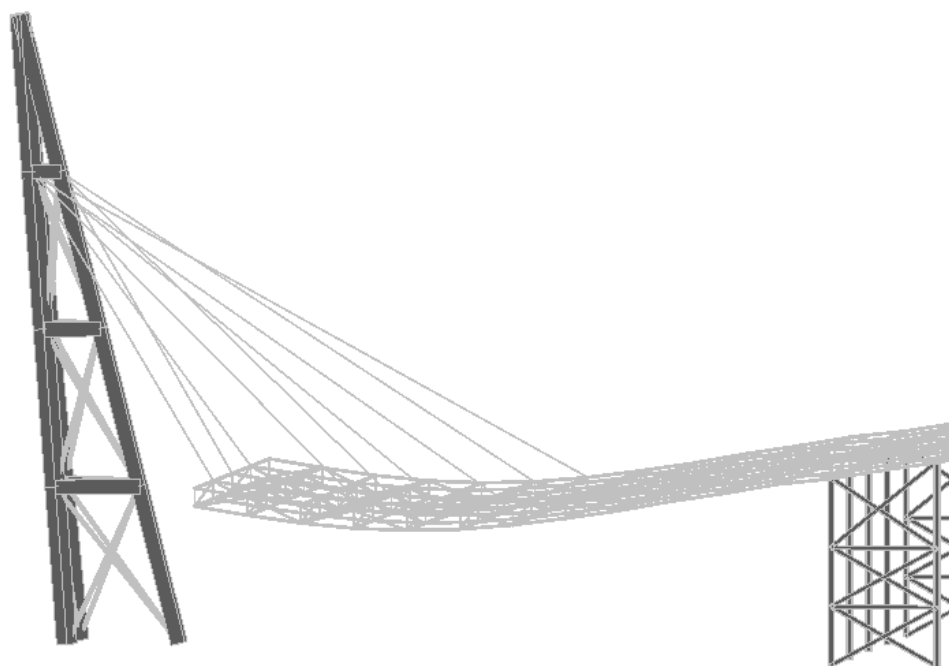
Конструкция пилона из железобетонных колонн
